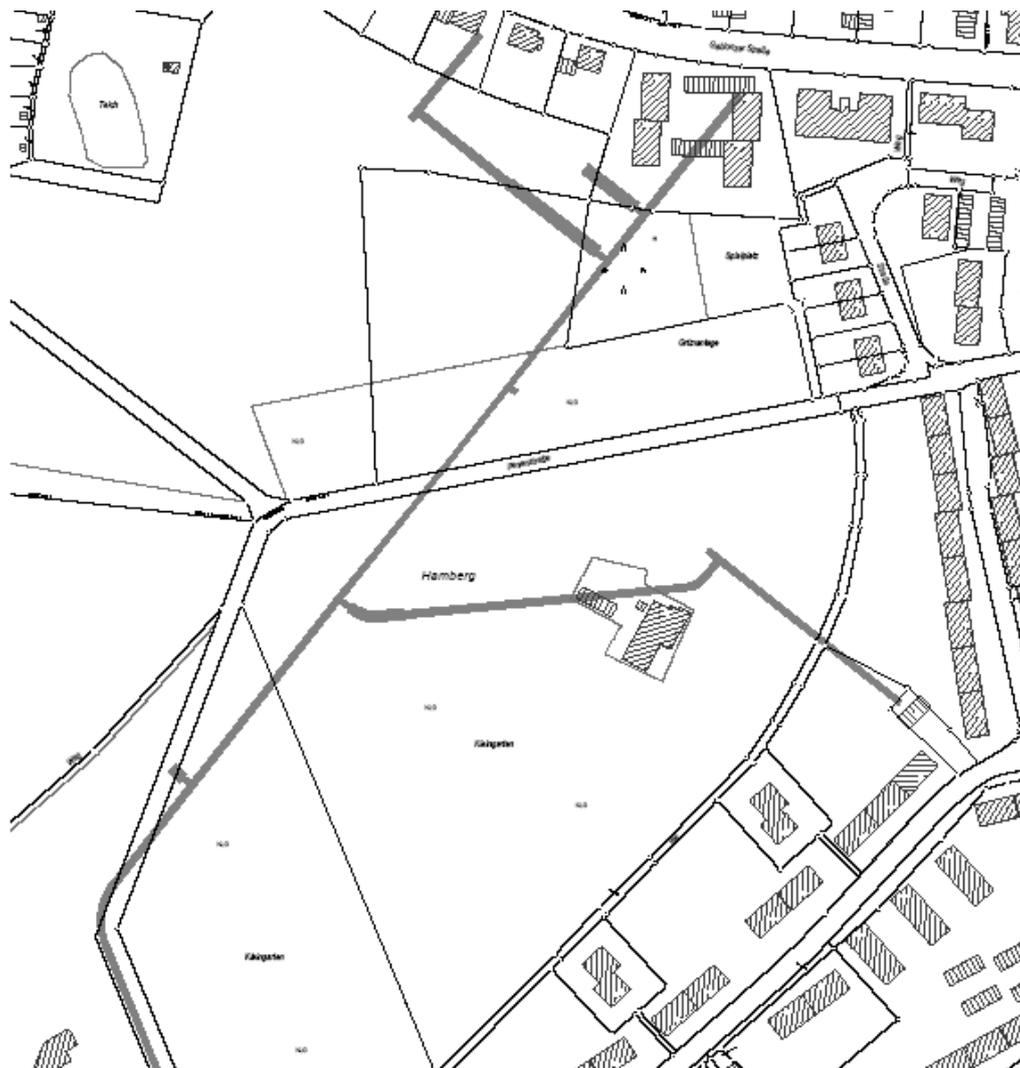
Lageplan Luftschutzstollen HAMBERG
